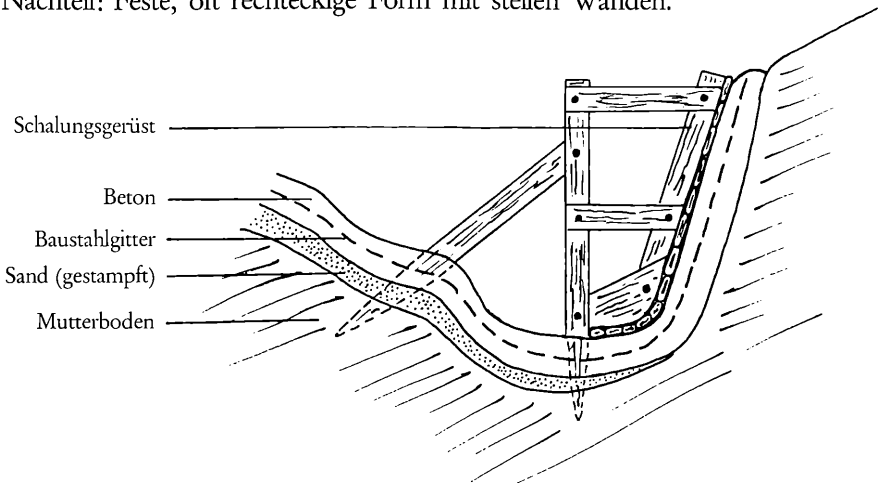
Betonbech, dessen Steilufer nur mit Verschalungen gebaut werden können
